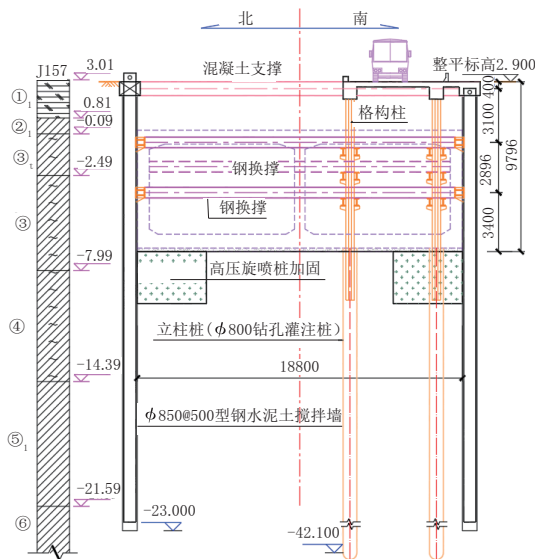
隆昌路下立交基坑围护断面图(典型断面)(单位:mm)
